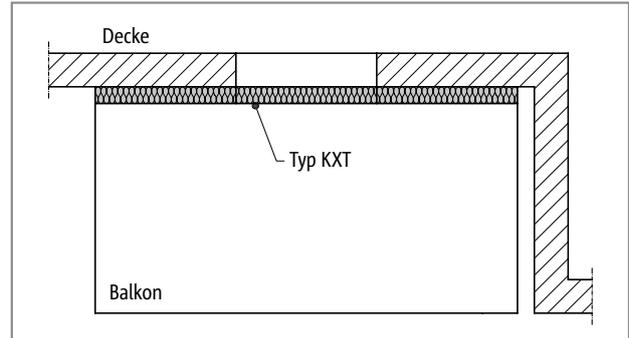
Schöck Isokorb® Typ KXT: Balkon bei Fassadenversprung
